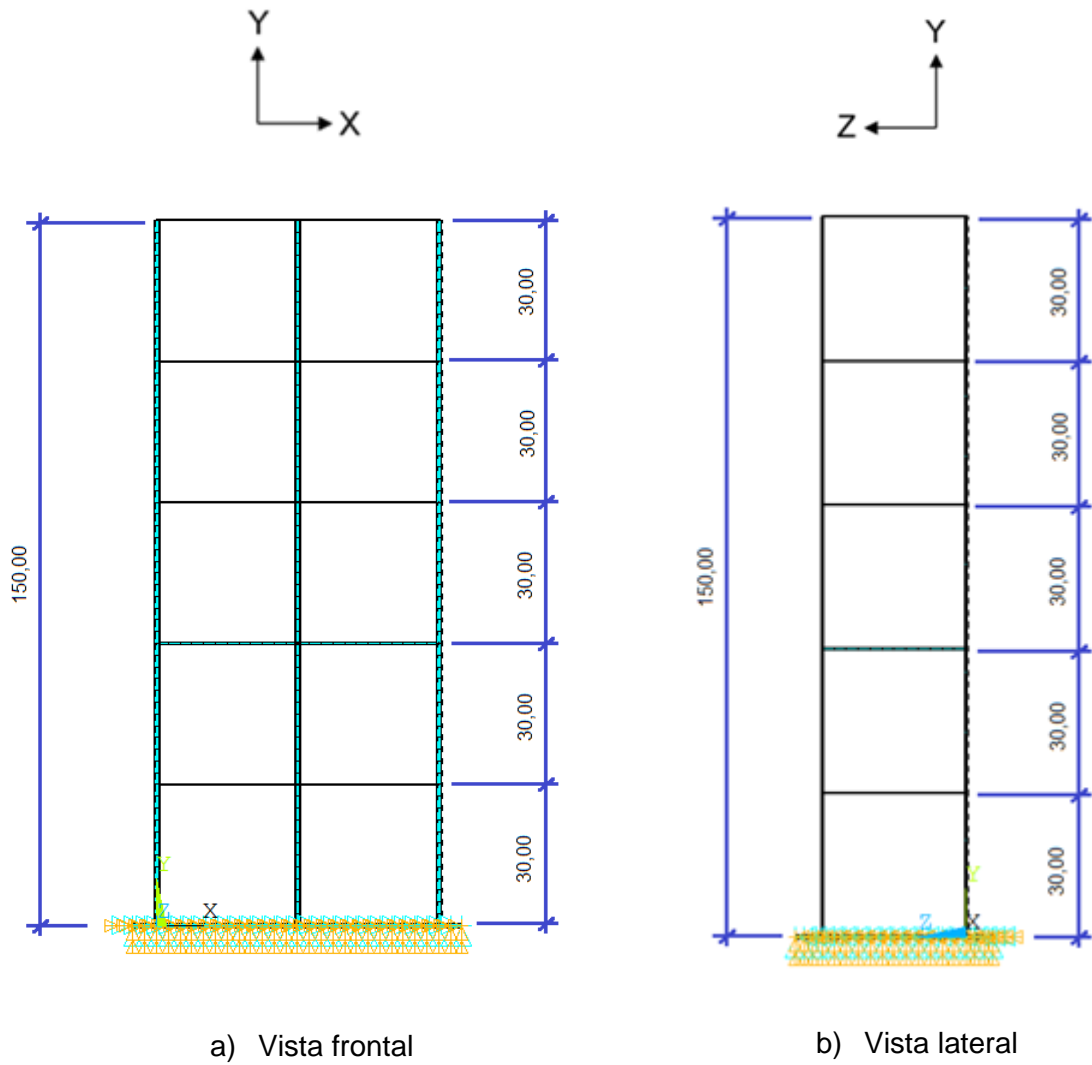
Vistas em elevação do MEF. Dimensões: centímetros.
